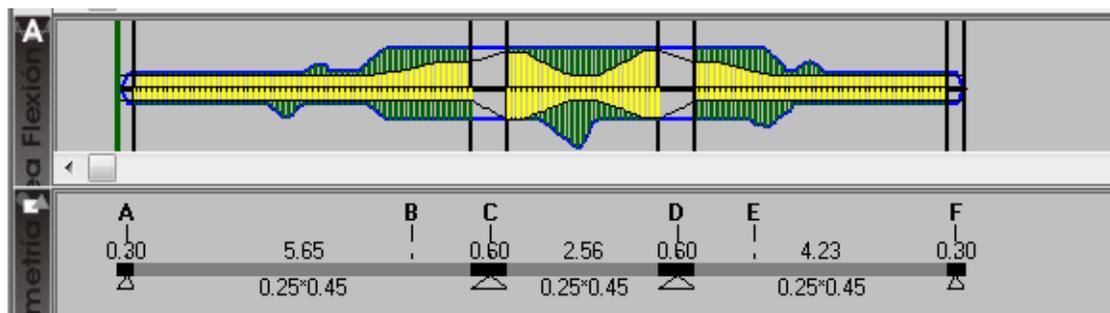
DCCAD 2010. Área de esfuerzo y área de refuerzo de un elemento
